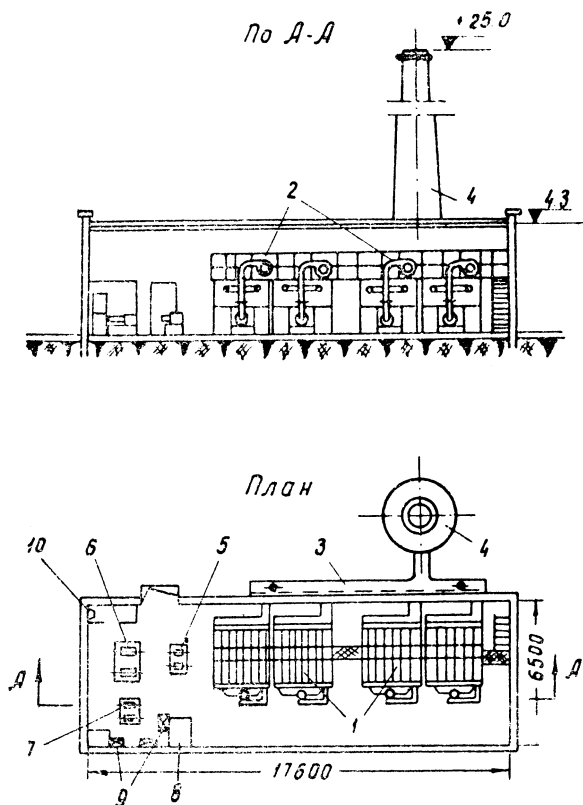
Отопительная котельная с чугунными секционными котлами, работающими на жидком топливе
